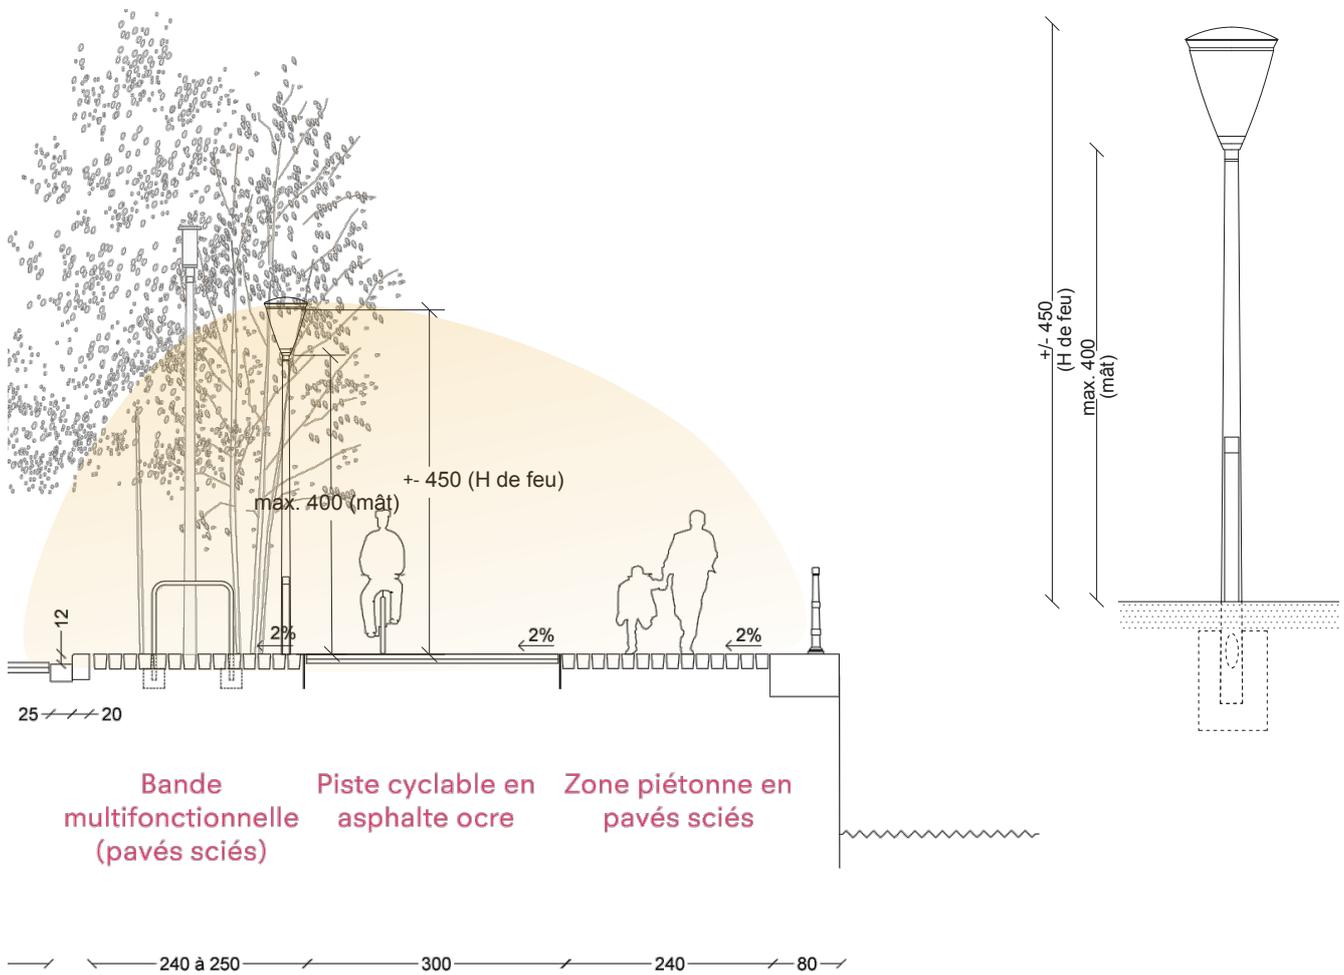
Coupe et plan type d'éclairage des quais en secteur Centre
